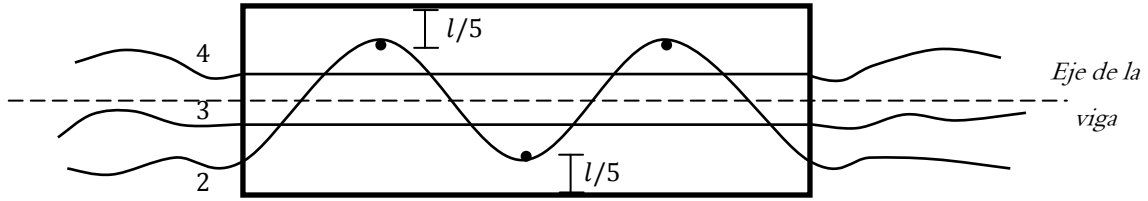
Vista inferior de la viga. Distribución de las fibras ópticas 2, 3 y 4.
